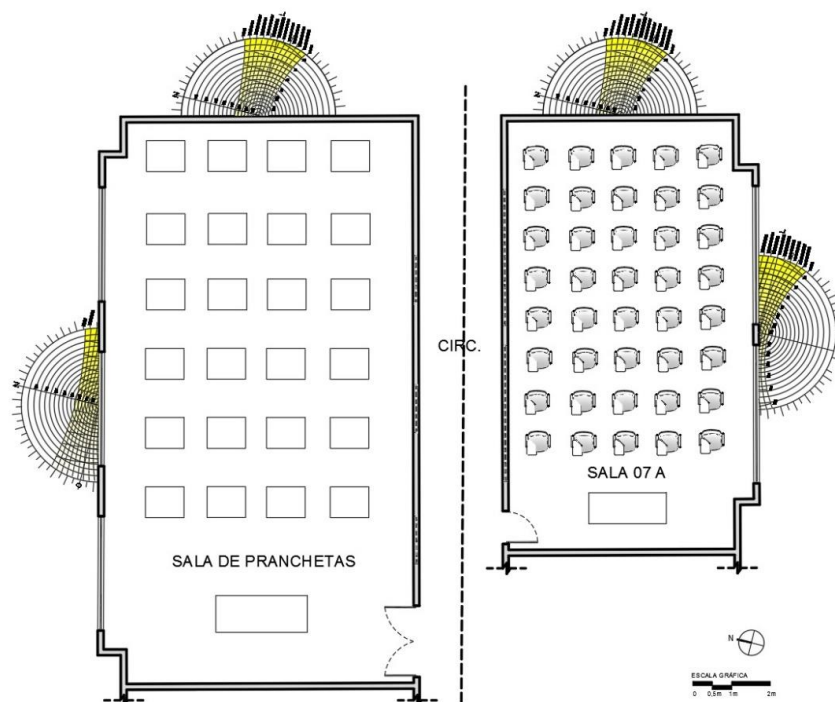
Análise solar em planta das salas 7A e sala de Pranchetas B.
